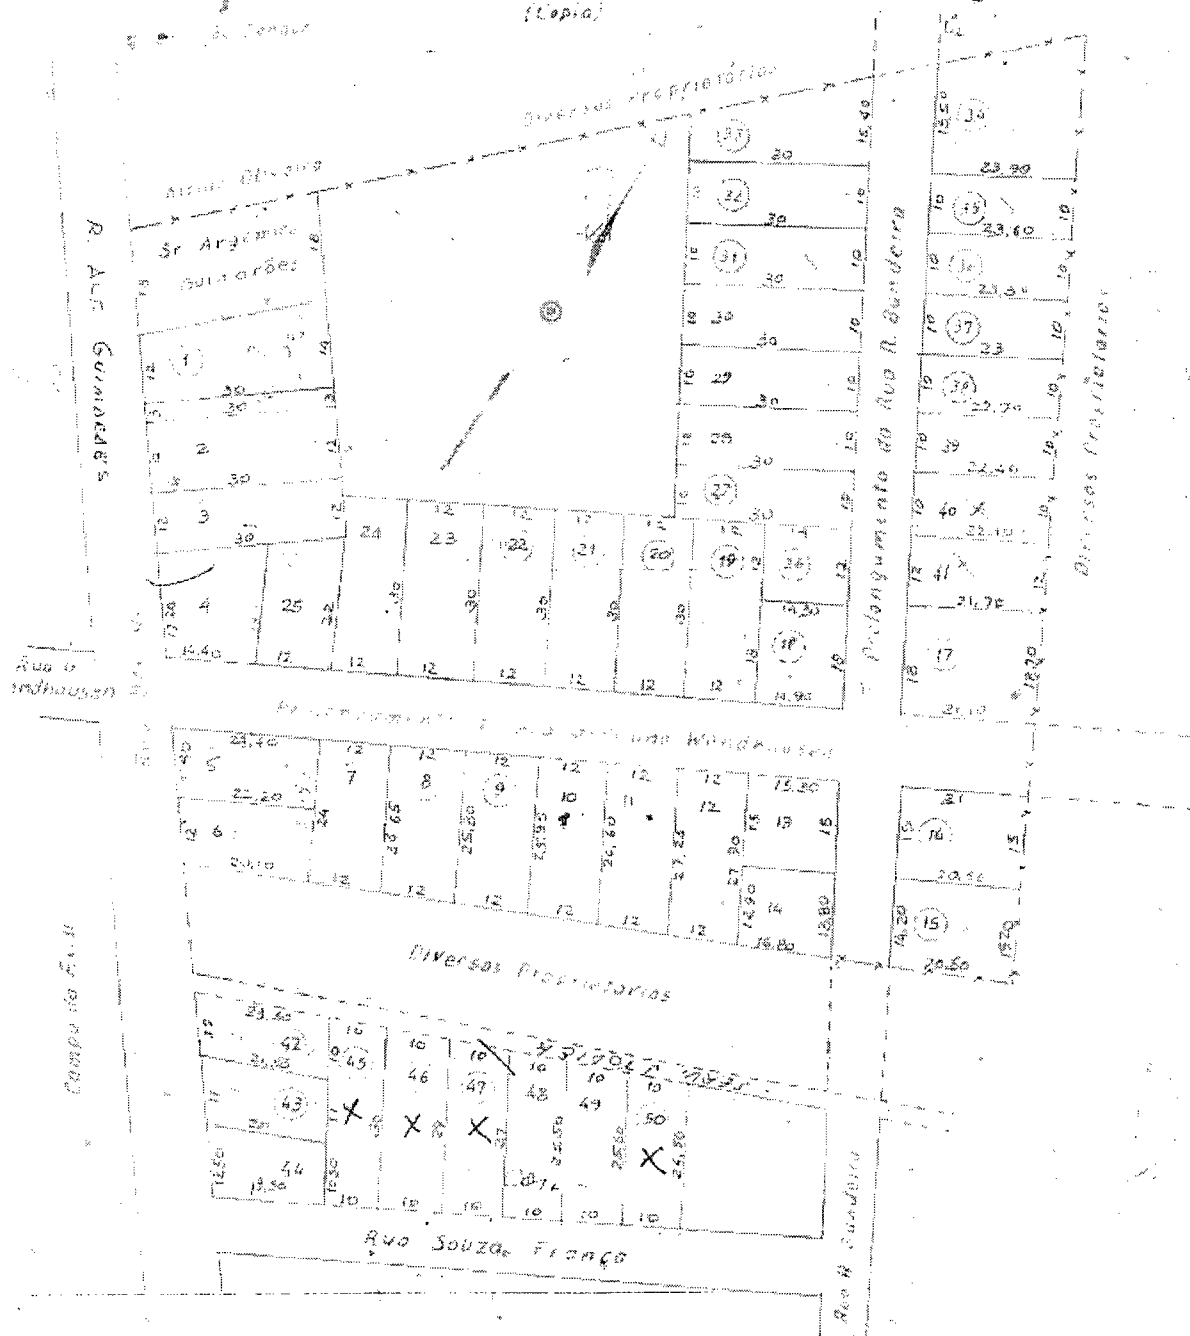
Planta do Loteamento aprovado em 19/07/1942.(Fonte: SUSP/ PMF)
